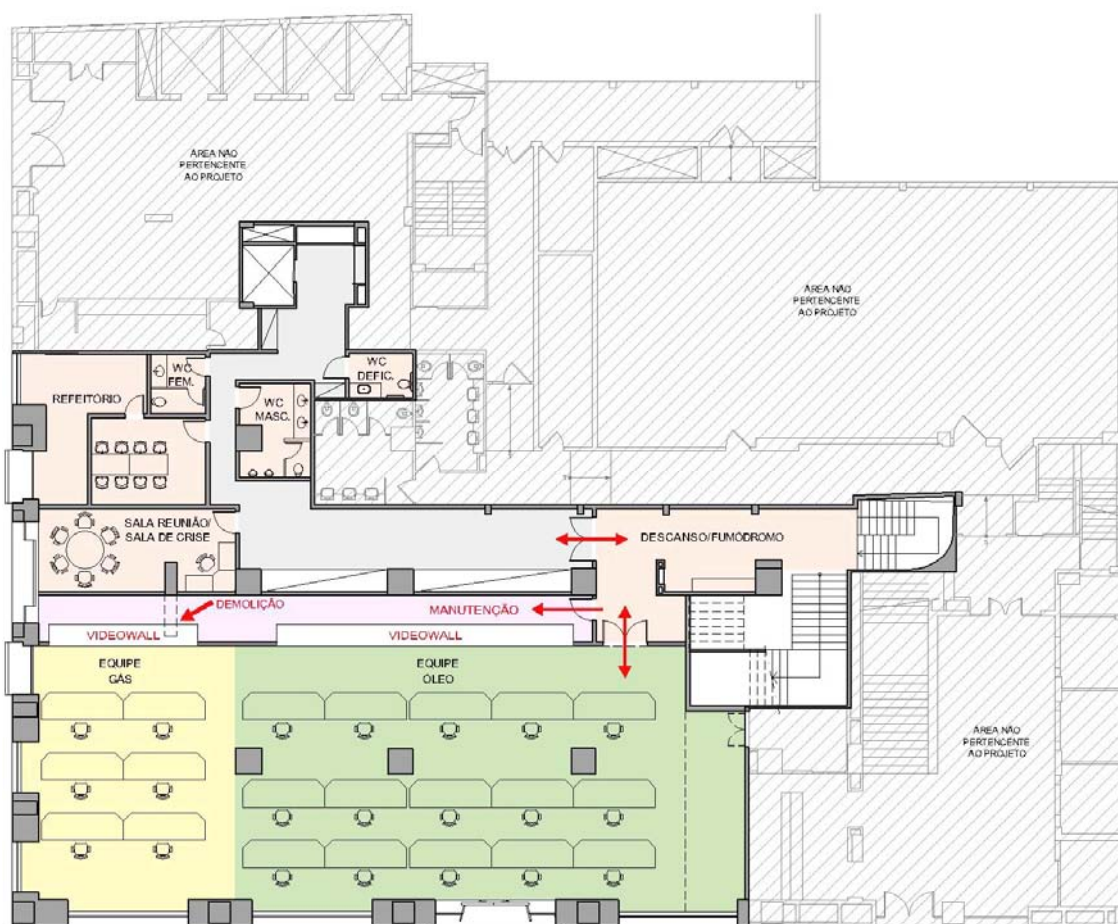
Planta baixa pavimento térreo: opção 2 para o layout (dois de junho)
